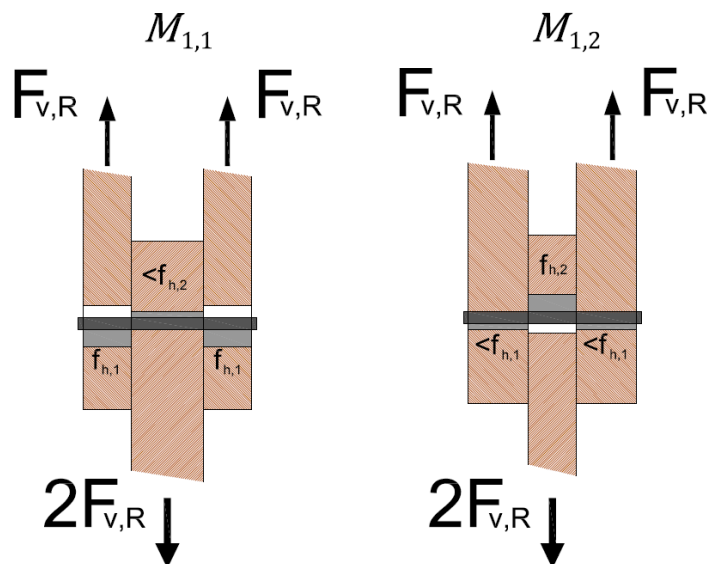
Modos de rotura 1 – ligações madeira-madeira em corte duplo. Faria (2009).
